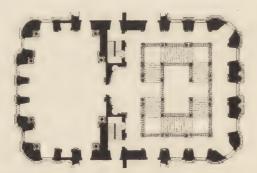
Schloß Pommersfelden, Grundriß des Mittelbaues.
